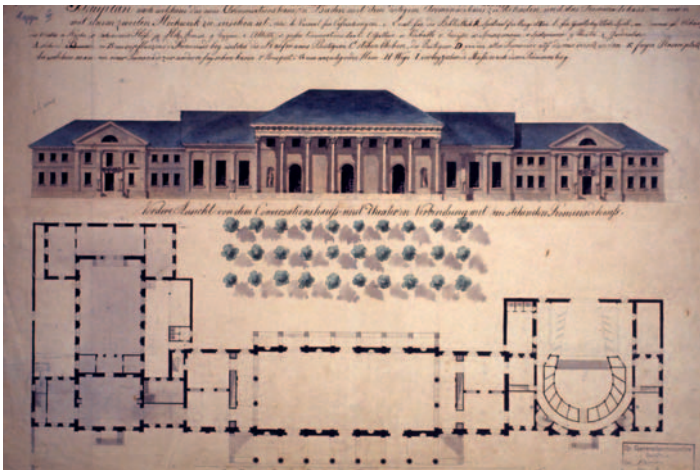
Baden-Baden: Erster Entwurf Friedrich Weinbrenners für das Konversationshaus. (GLA Karlsruhe G Baupläne Baden-Baden 63)
